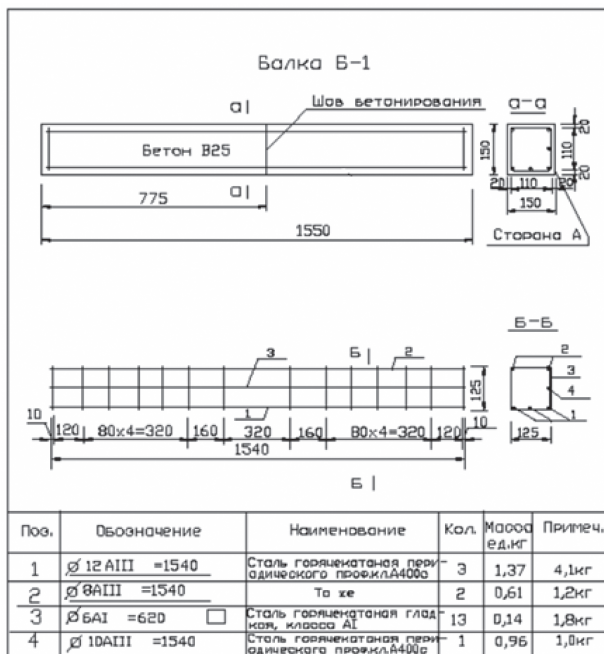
Арматурный каркас и схема армирования балки-модели для испытания на косоу изгиб
